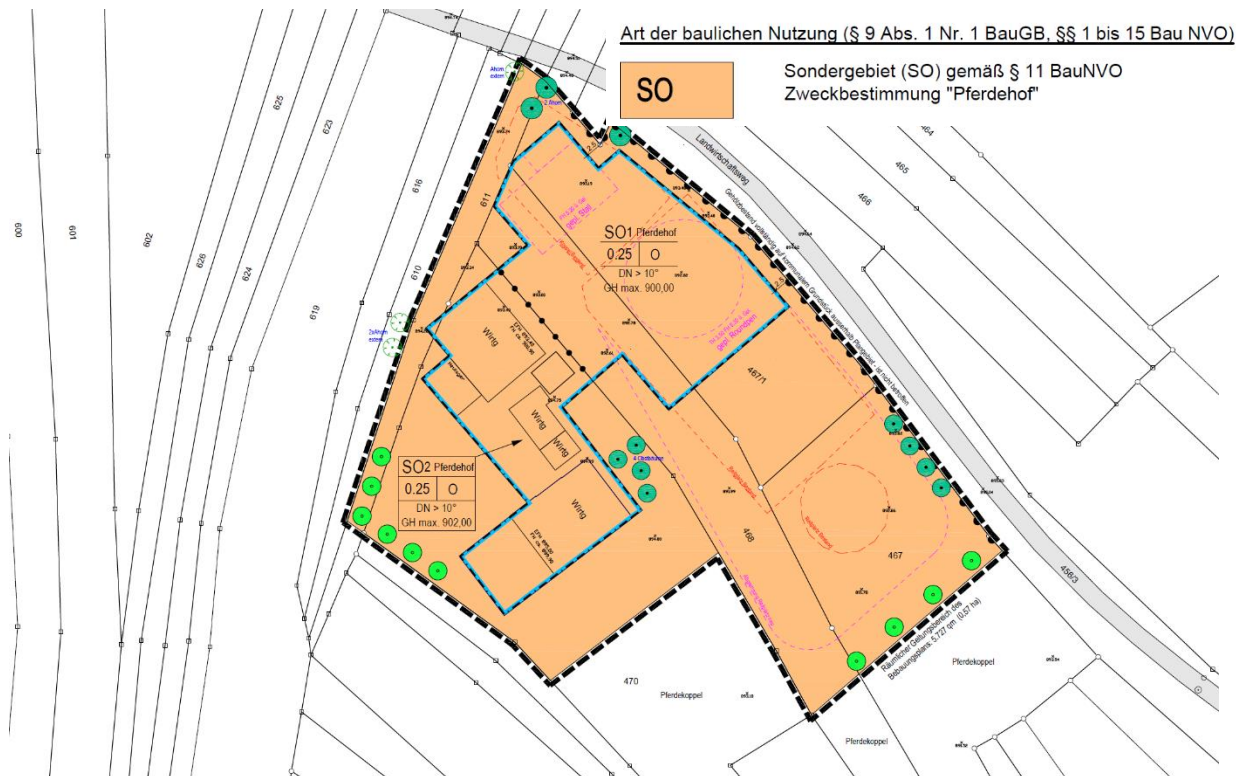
Bebauungsplan Vorentwurf, (R. Stehle, April 2023)
